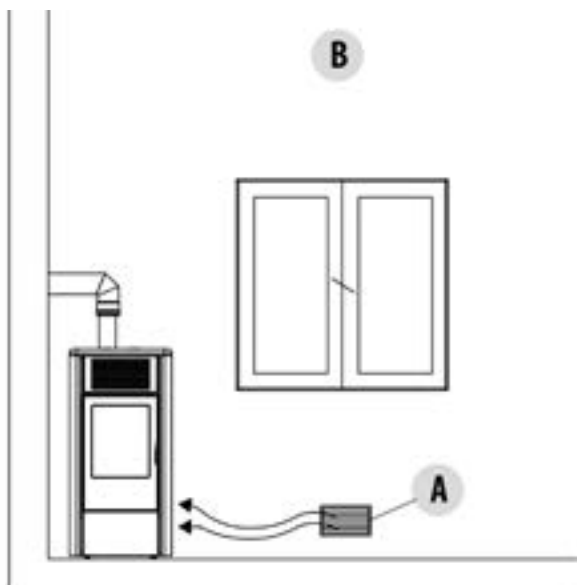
Soluzione 1 = direttamente dall'esterno
